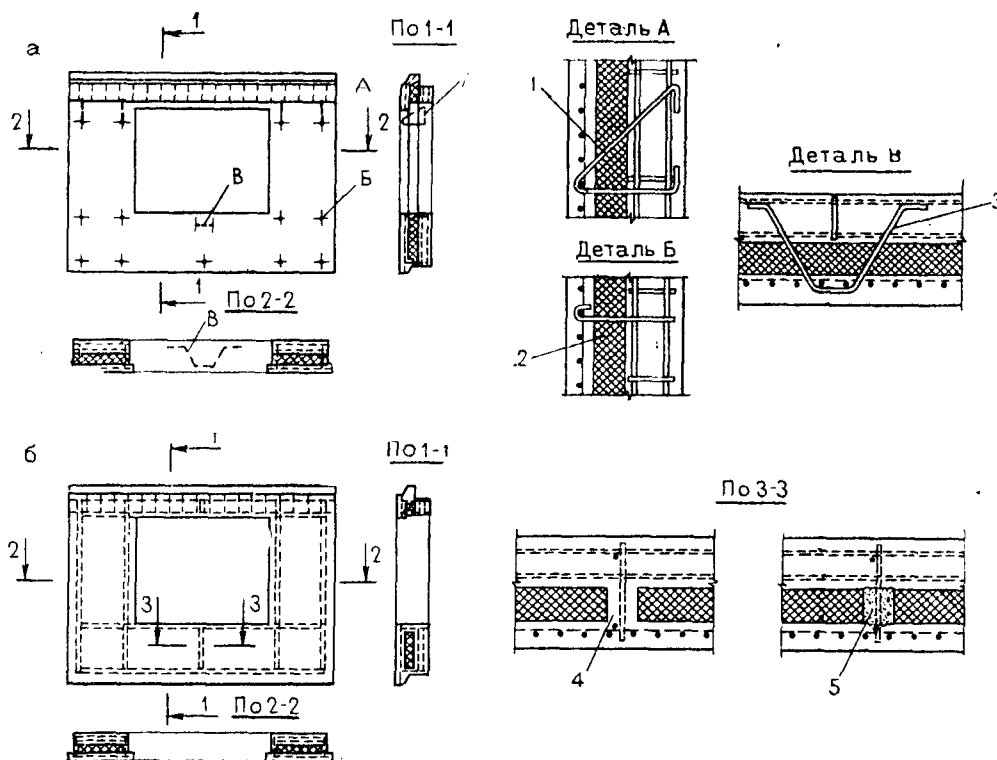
Связи бетонных слоев в трехслойных панелях
